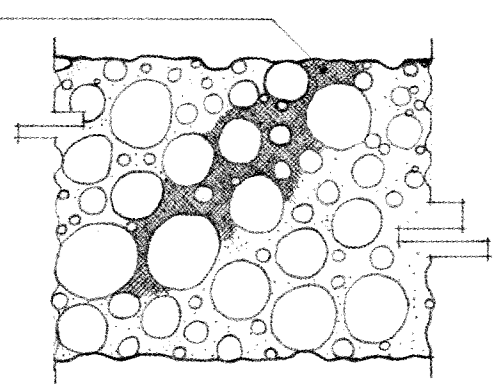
Muro de piedra natural redonda, con junta de mortero. La transmisión de cargas no es adecuada; además, se utiliza gran cantidad de mortero en las juntas.
